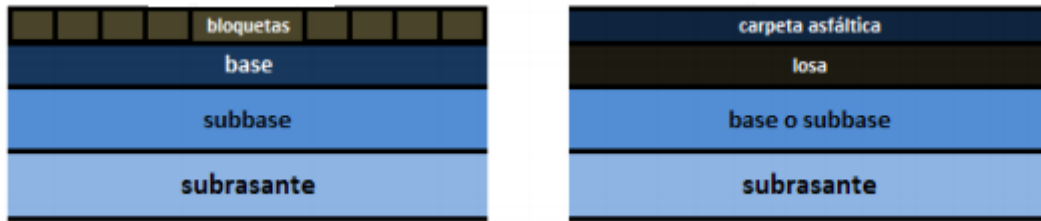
Estructura del pavimento. Fuente: Becerra, M. (2012)
